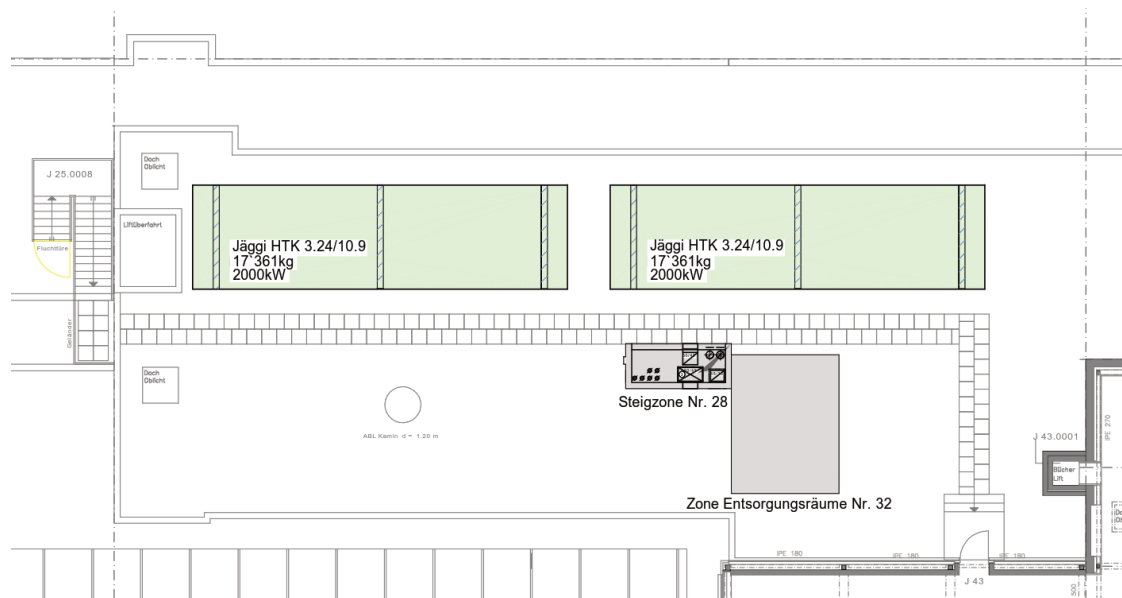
Rückkühlanlage 2, Dach des Flachhauses, Geschoss J
